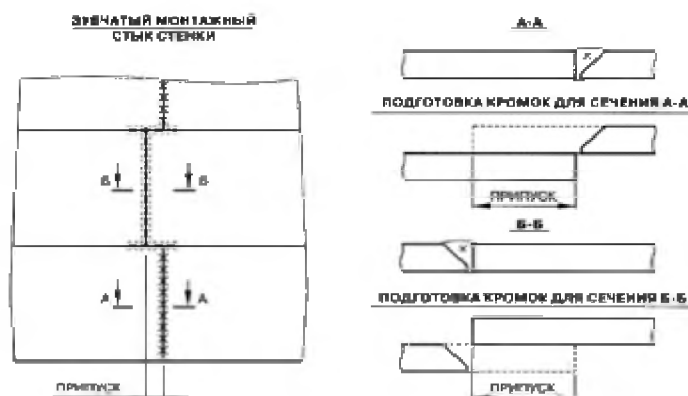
Зубчатый монтажный стык стенки резервуара
